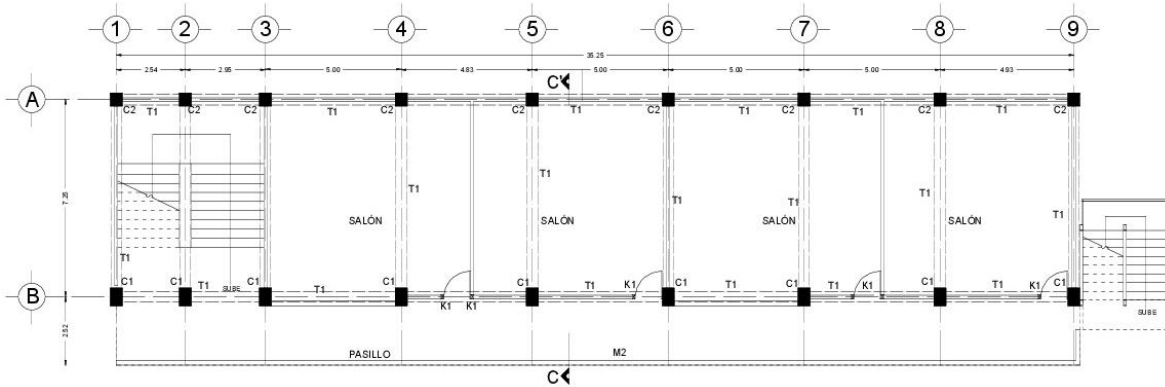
Croquis de dimensiones y elementos en planta del N1. (GACONSA, 2018)
